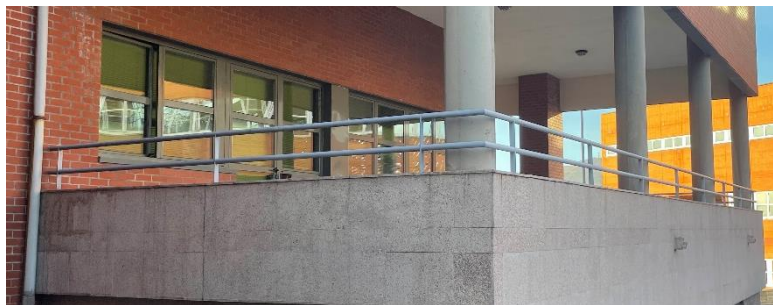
Fotografía de las barandillas instaladas sobre el muro de la planta baja
